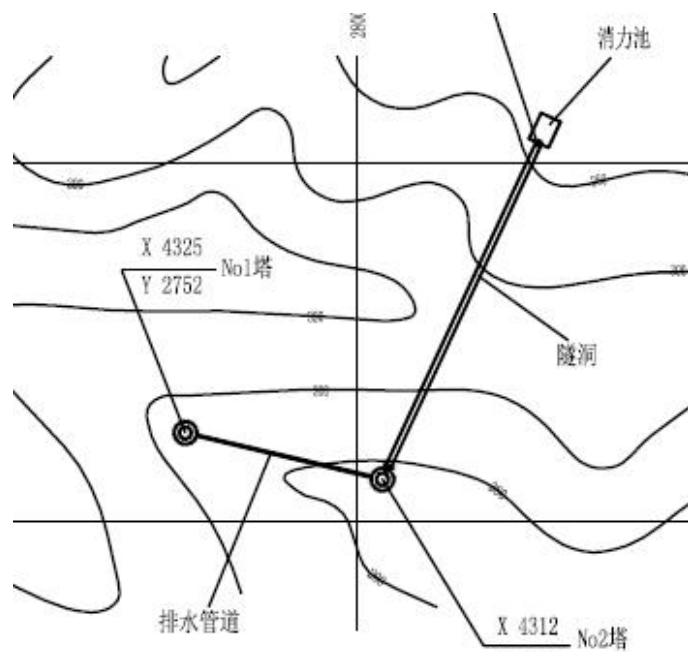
白枣峪尾矿库加高设计排洪系统平面图
